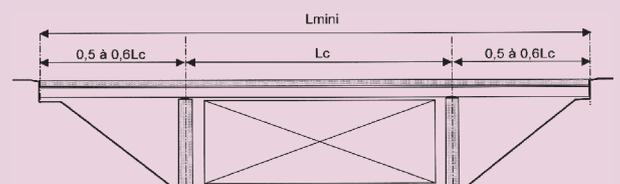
Ouvrage avec position des piles imposée et travées de rive « courtes »
